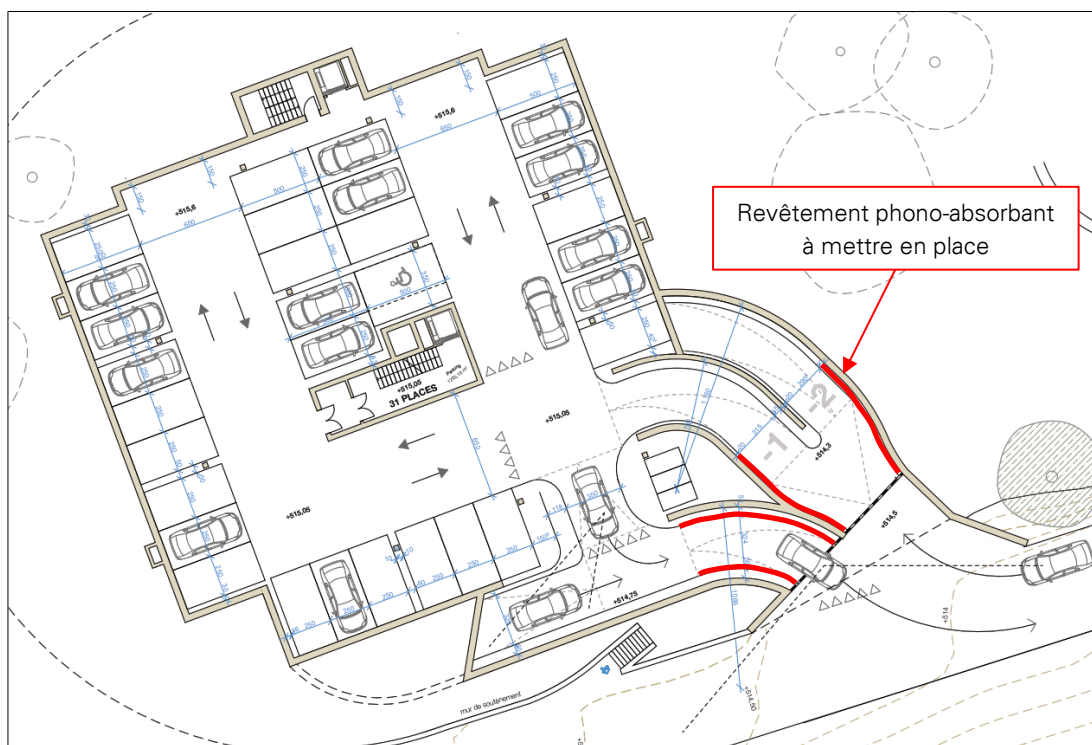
Localisation de la rampe du parking souterrain (plan d'intention provisoire)
